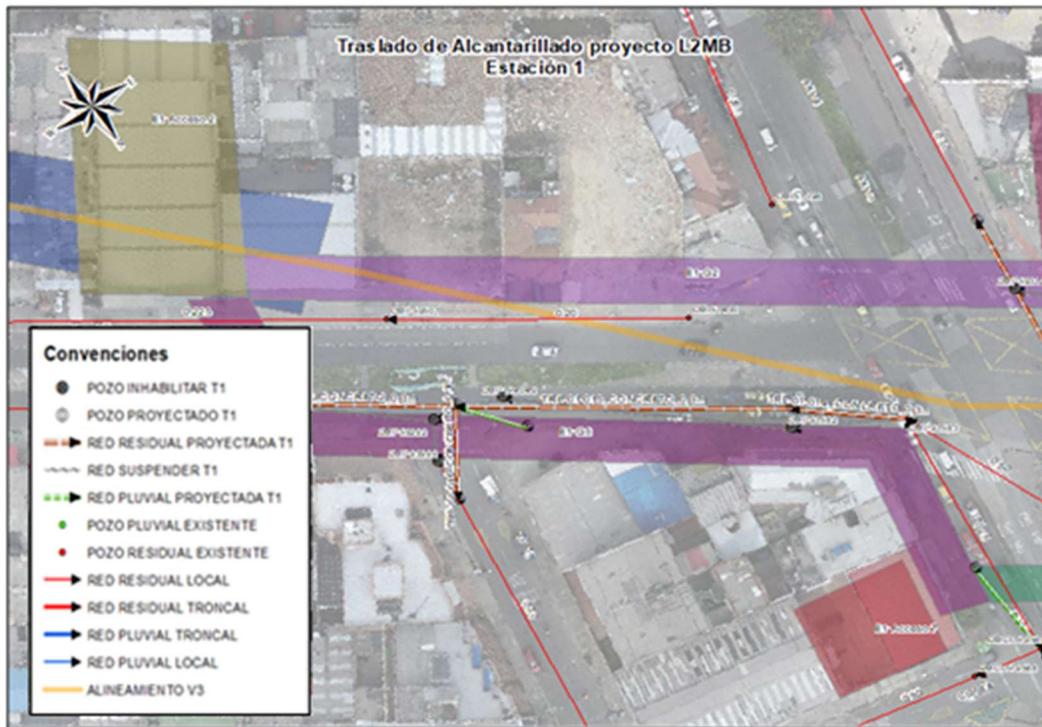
Traslado redes de alcantarillado Estación 1 Calle 72 Carrera 17
